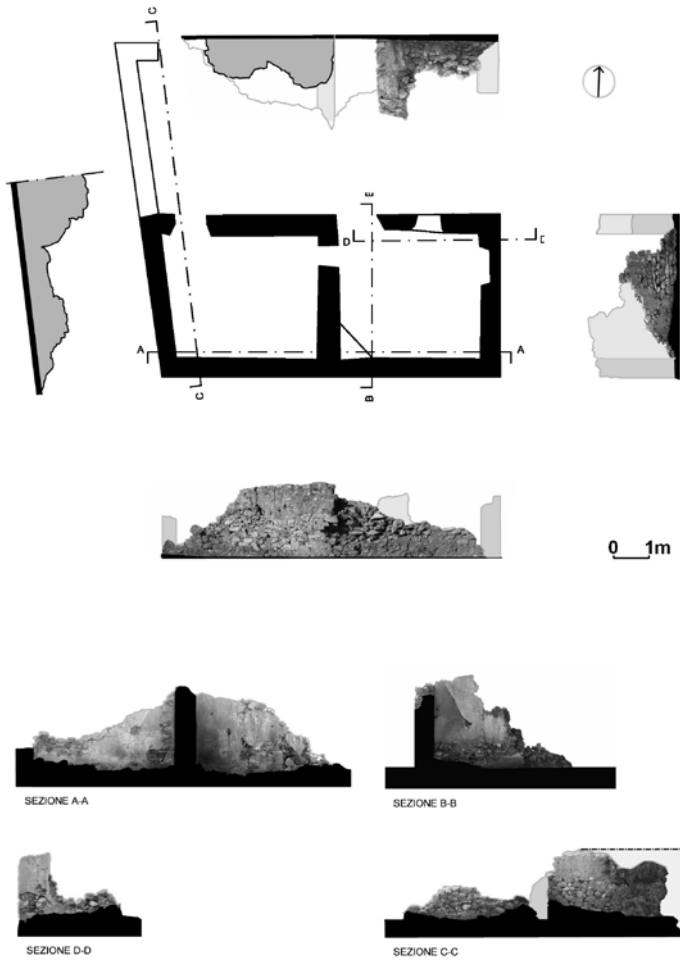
Pianta, sezioni e prospetti dell'unità abitativa studiata
